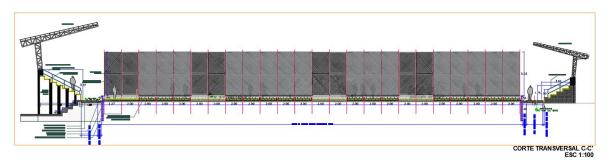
Pantallazo diseño micropilotes. Planimetría Arquitectónica – Secciones, corte transversal
